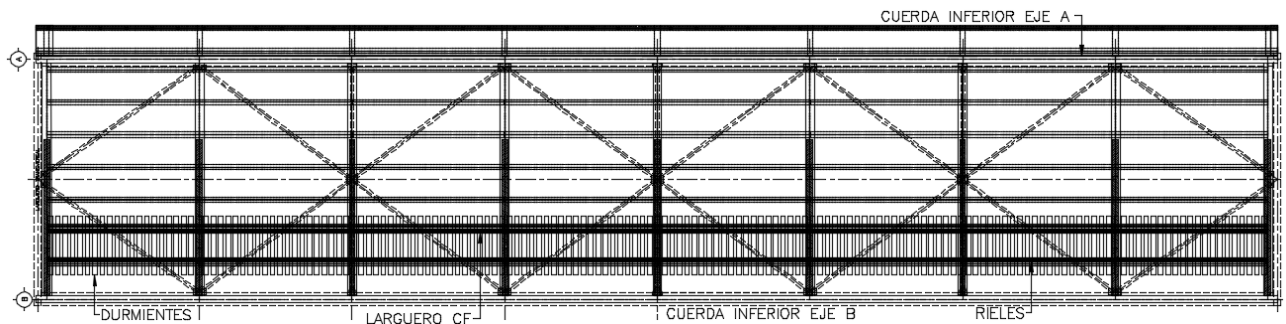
Detalle de elementos de contraventeo de las armaduras [22]
